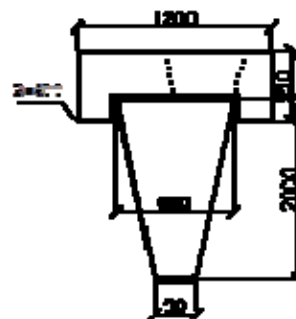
Пирамидальная свая с сборным железобетонным ростверком
